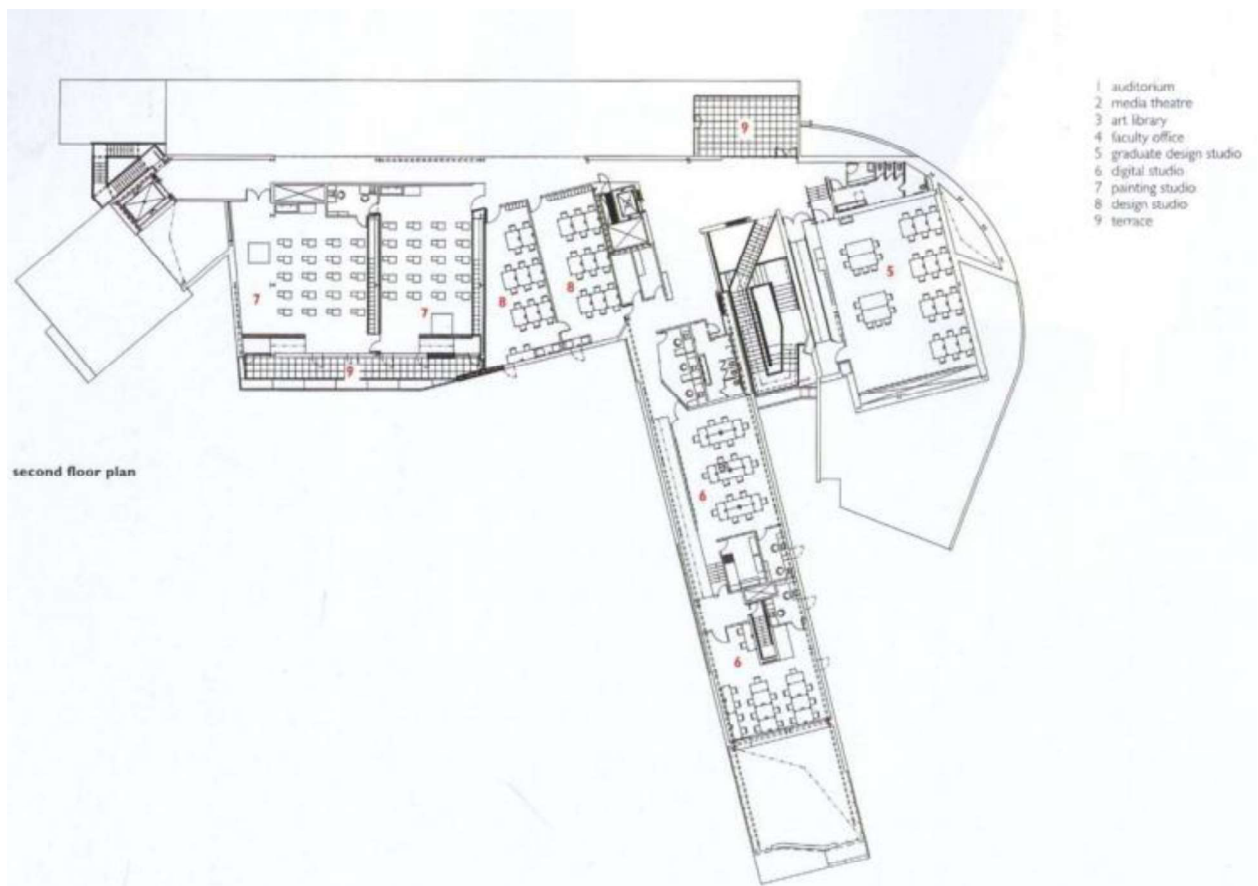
Planta Baixa do segundo Pavimento (fonte: Architectural Record, 2007).
